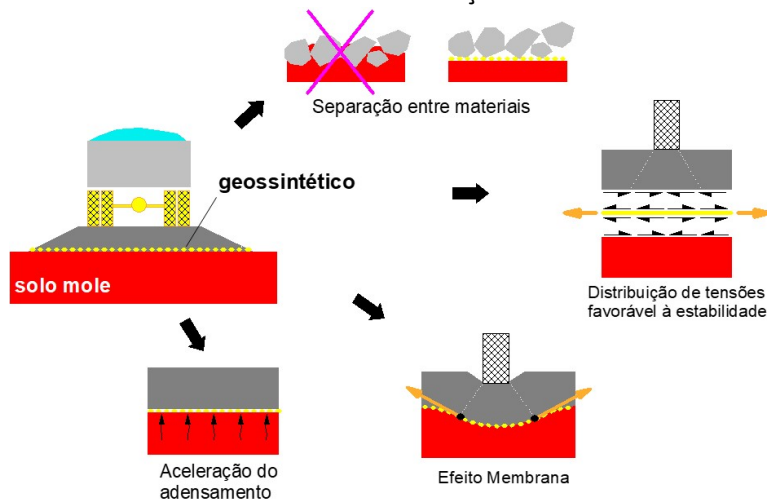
Benefícios da presença de reforço geossintético em estradas não pavimentadas
